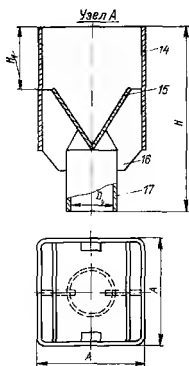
Установка ГП с приспособлением для его настройки.
